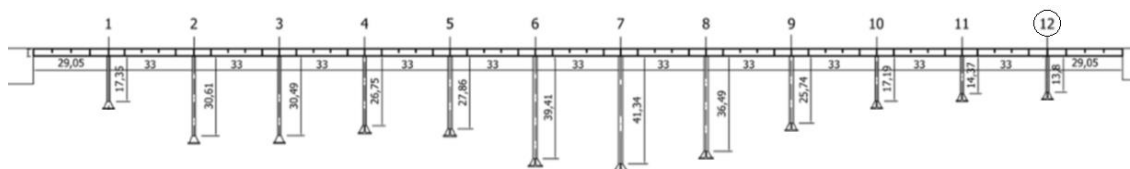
Perfil longitudinal da ponte sobre o Rio Torto [42, 44]
